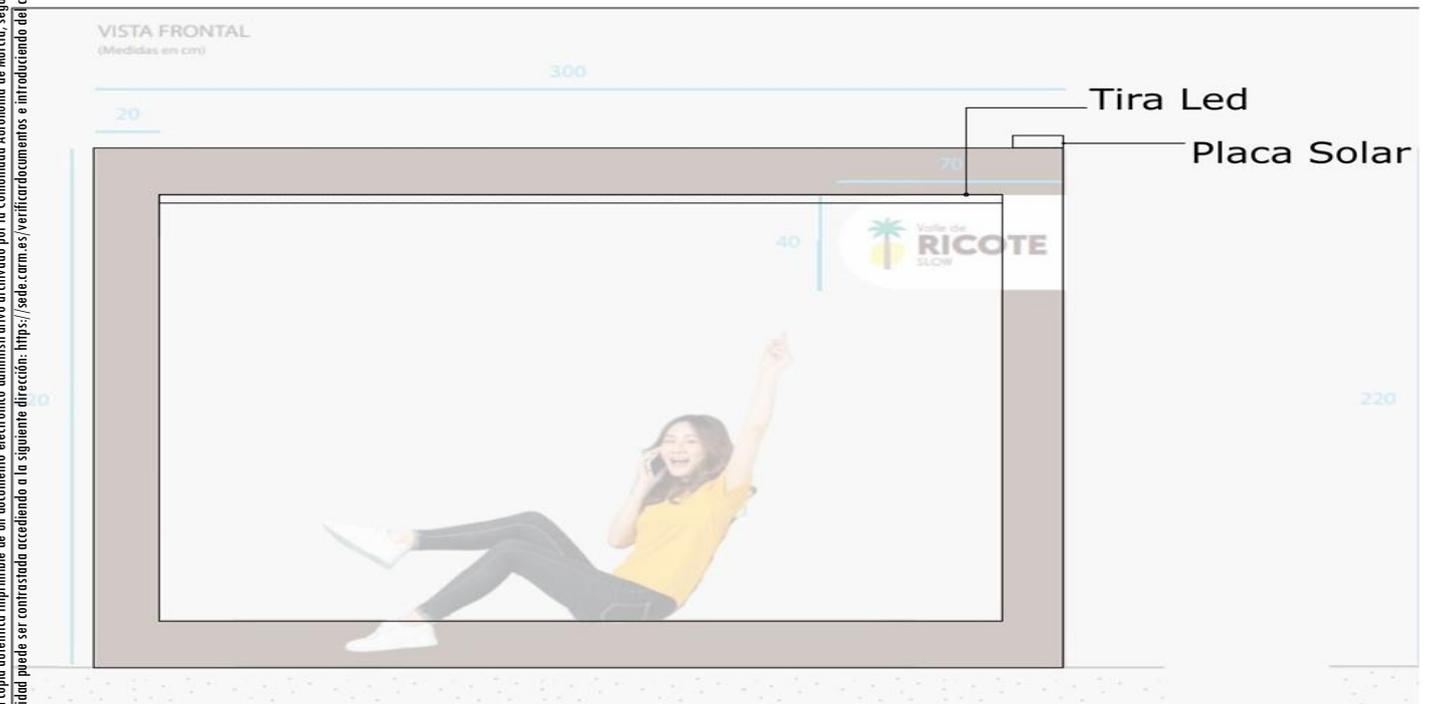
Detalle Lámparas Solares instaladas a Photocall
